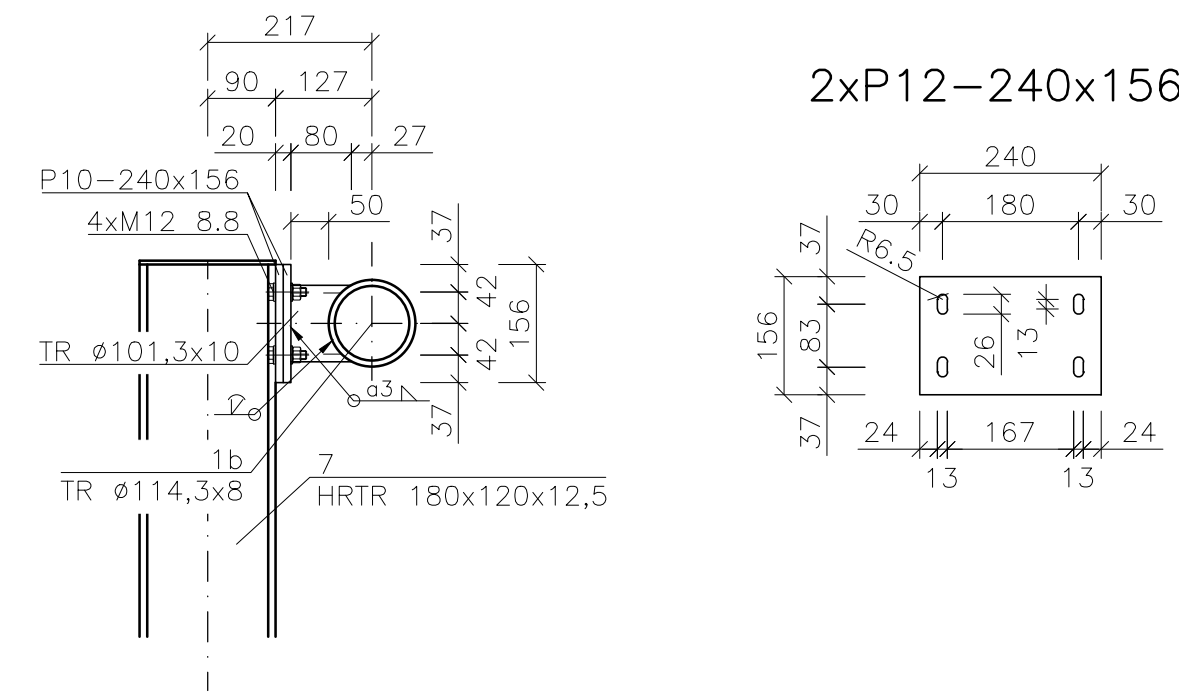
DETAIL PŘIPOJENÍ ČELNÍHO SLOUPU
